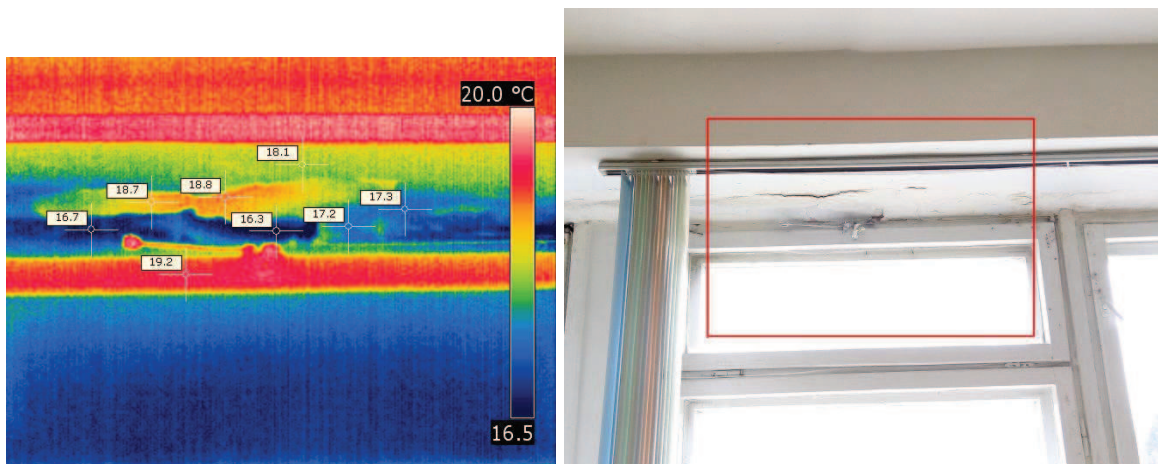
Стена помещения №229 (учебный класс), восточный фасад
